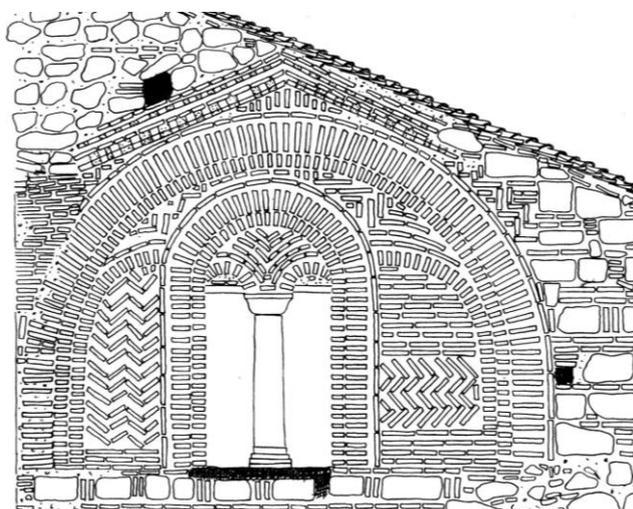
Triple nicho semi-circular de la fachada sur de la planta superior del nártex, s. XIII.
